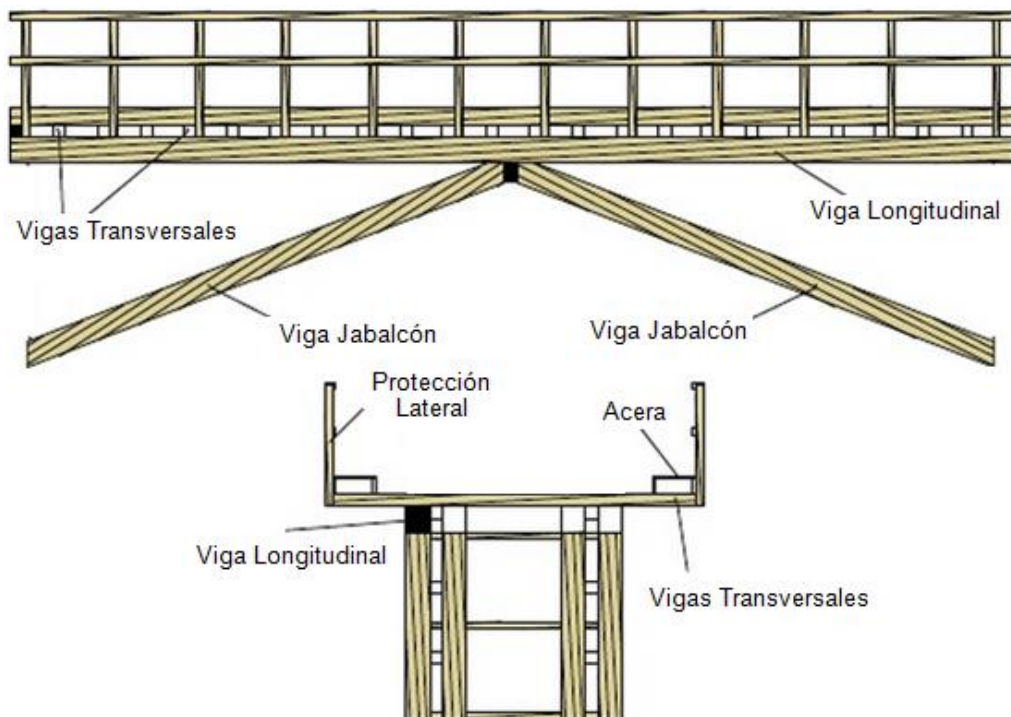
Sección transversal de vigas con apoyo intermedio a tope [14]
